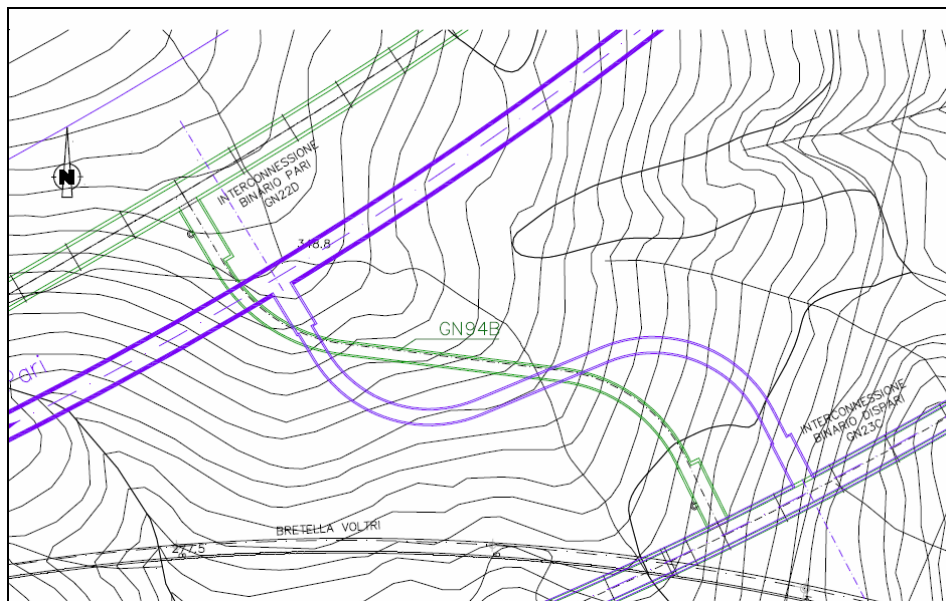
Confronto planimetria by-pass GN94B previsto da PD e in PE
